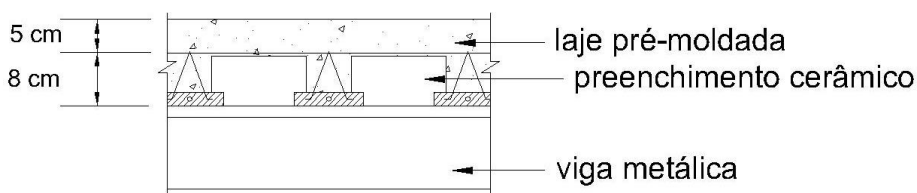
Seção transversal da viga mista utilizando laje pré-moldada (Autora (2017))
